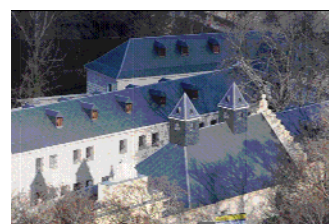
Detalle de las dos chimeneas forradas completamente con teja. Fotografía facilitada por Eduardo de la Torre.
